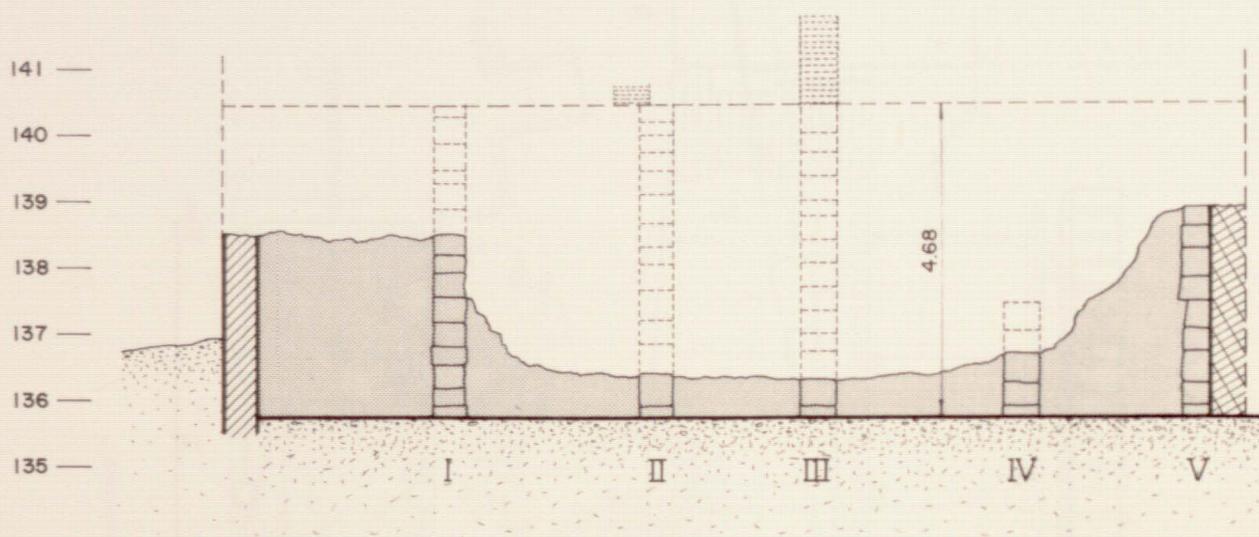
Pórtico de Dos Pisos, piso bajo, reconstrucción de la pared de retención con pilastras.
